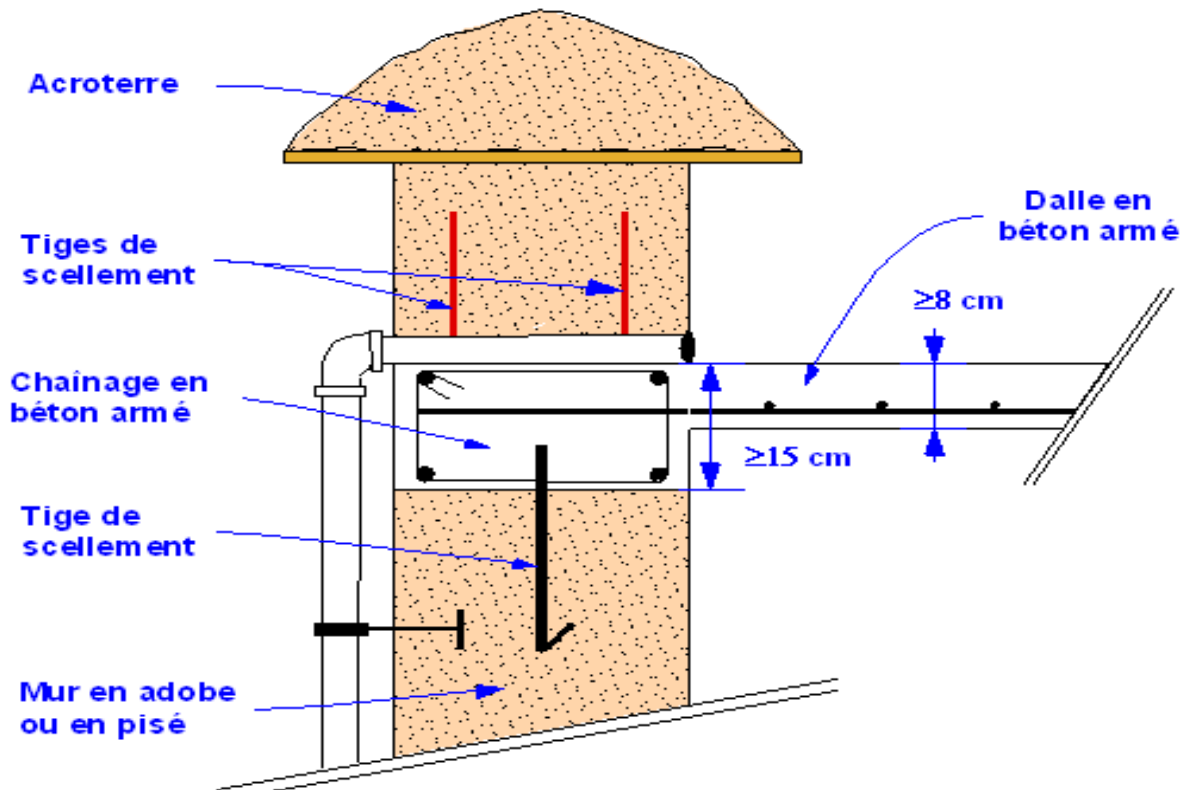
Chaînage horizontal en BA, toiture en BA attache mur - chaînage
